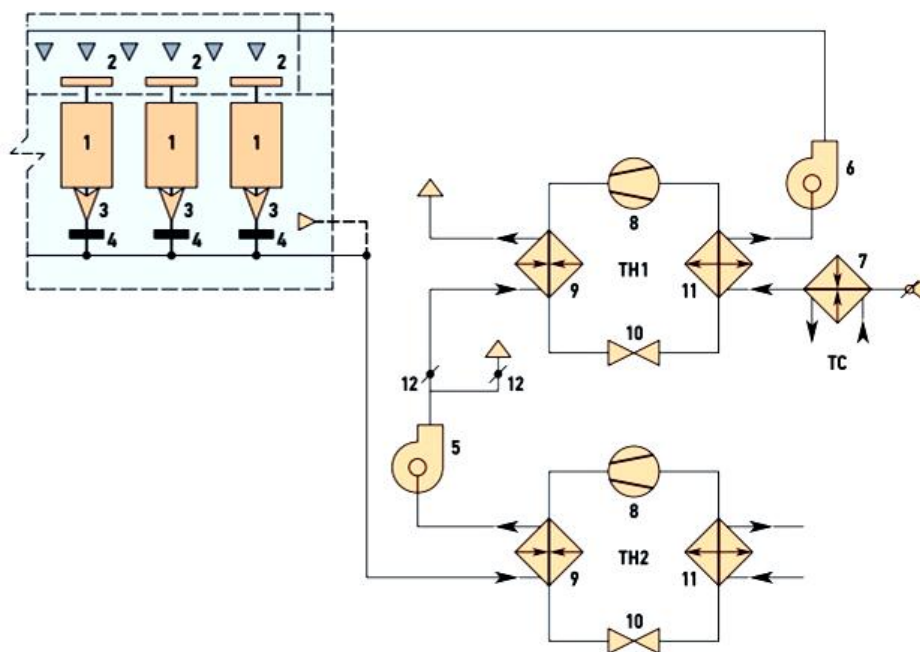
Схема для отопления нагнетателей и ГВС многомашинного компрессорного цеха: 1 – ГТУ; 2– нагнетатель газа; 3 – местный отсос; 4 – огнезадерживающий клапан; 5 – вытяжной вентилятор; 6 – приточный вентилятор; 7 – воздухонагреватель; 8 – компрессор; 9 – испаритель; 10 – терморегулирующий вентиль; 11 – конденсатор; 12 – клапаны.
